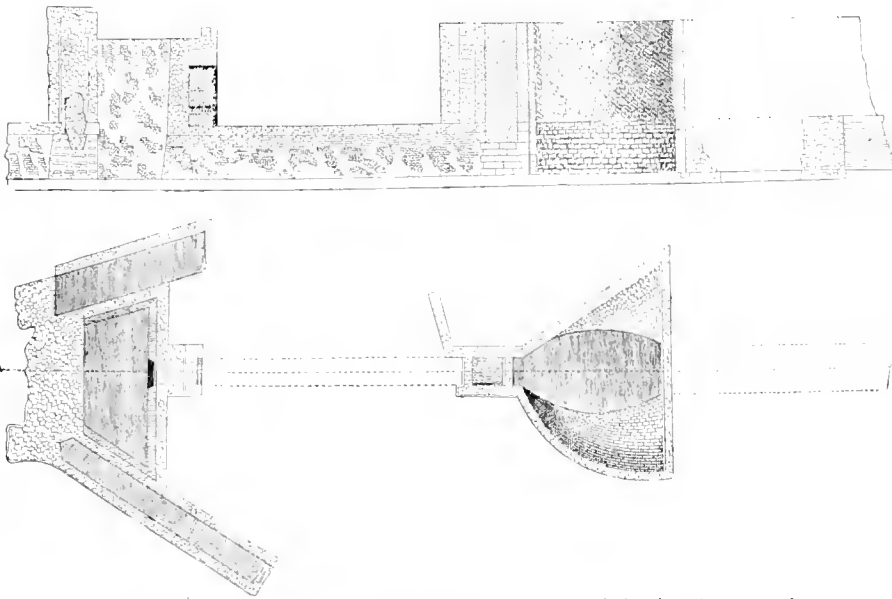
Émissaire du lac Fucin : vasques en tête de la galerie, plan et coupe en long.
